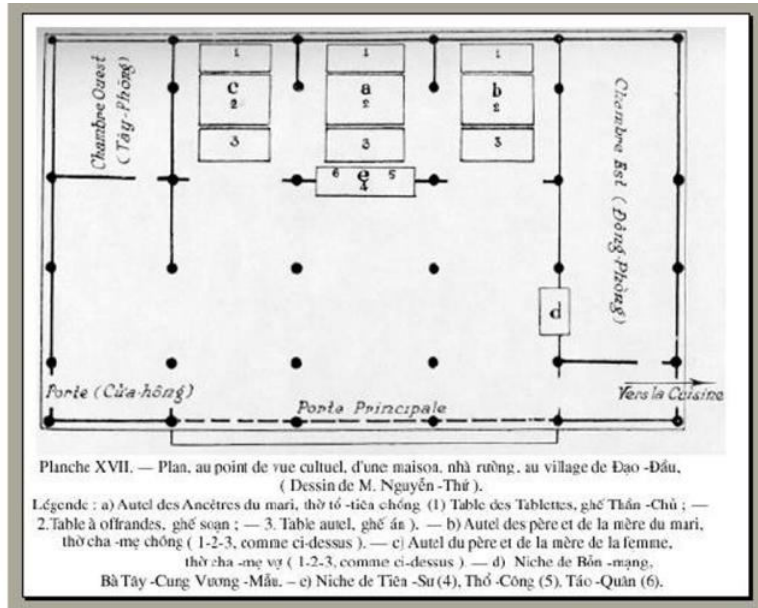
, 108 : Plan et coupe typiques d'une maison nhà rường ;
